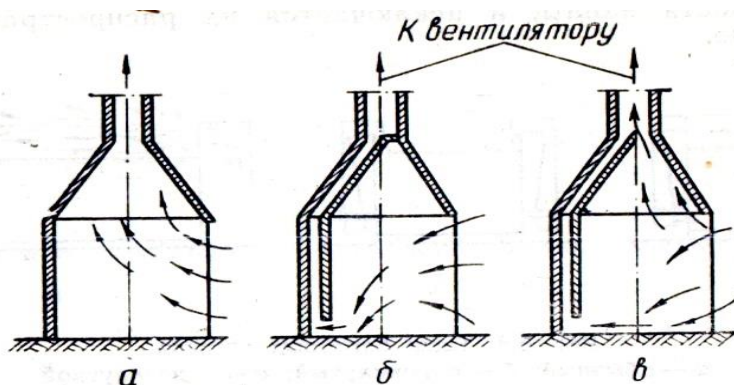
Лабораторный вытяжной шкаф с удалением воздуха из верхней (а), нижней (б), верхней или нижней (в) зоны. Учебник «Пожарная безопасность в строительстве» Часть 1 пожарная безопасность систем отопления и вентиляции
